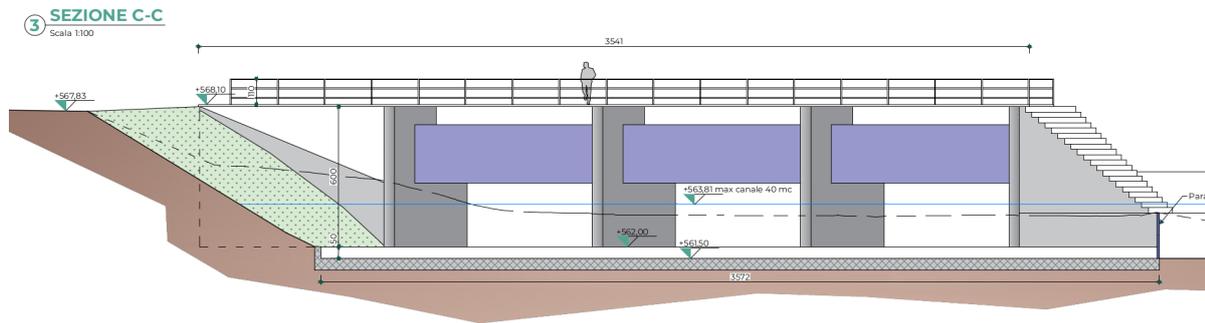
Vista in sezione del sistema di paratoie di sicurezza all'imbocco di monte del canale Paravera.
